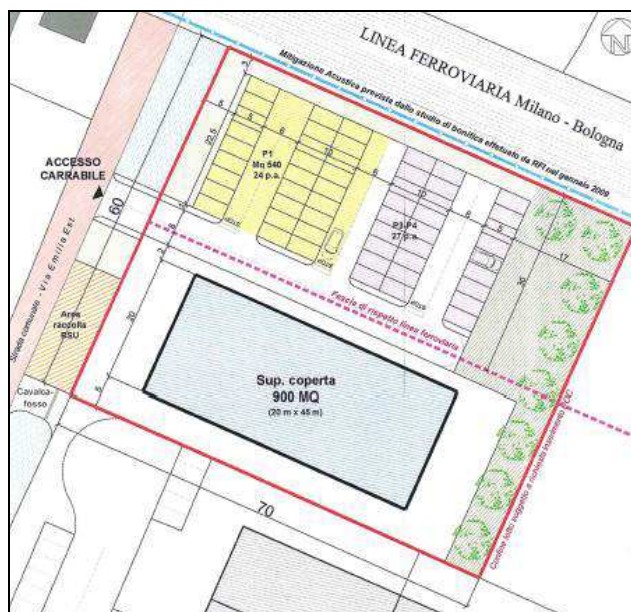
Planimetria del progetto d'inserimento nel POC-5 dell'area da destinare ad attività culturali della religione islamica.
